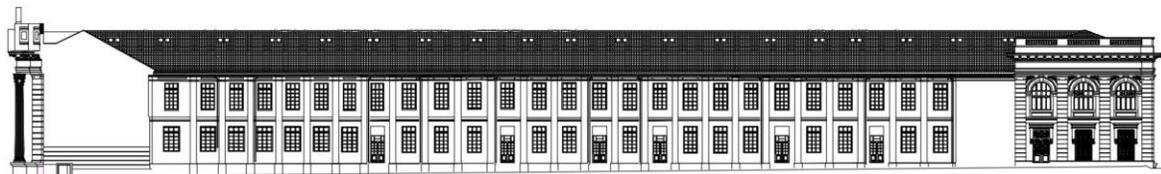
Fachada sobre carrera 15 (Milla) -- LA FACULTAD
